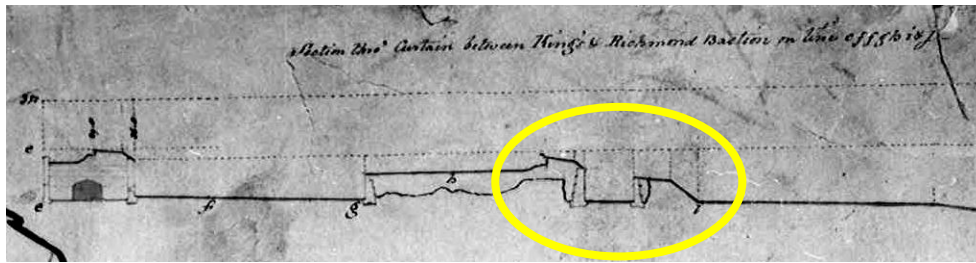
plan de 1827 – Profil des construction illustrant le niveau du roc à certains endroits (132-00-ic-18c)
